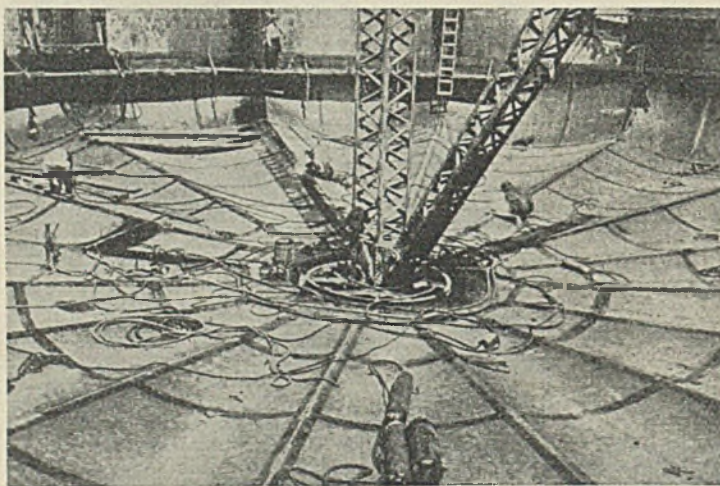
Montage des Behälters. Verschweißen der Bodenbleche.
